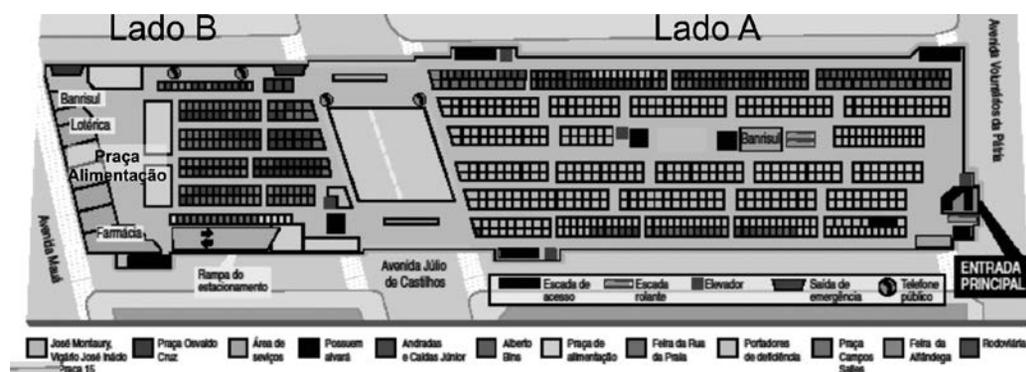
| Planta do segundo pavimento do CPC. Fonte: Inauguração, 2009.
